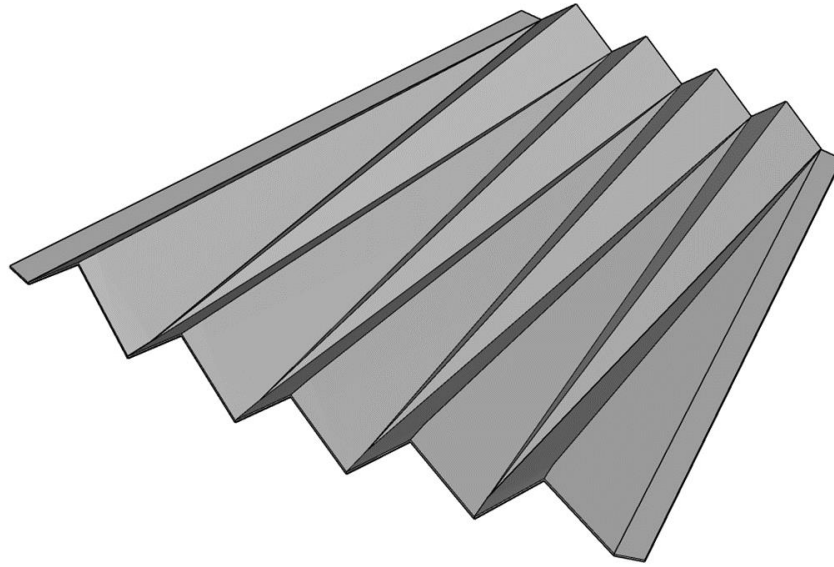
Geometría de la cubierta de pliegues alternados del Teatro Municipal Amira de la Rosa.
